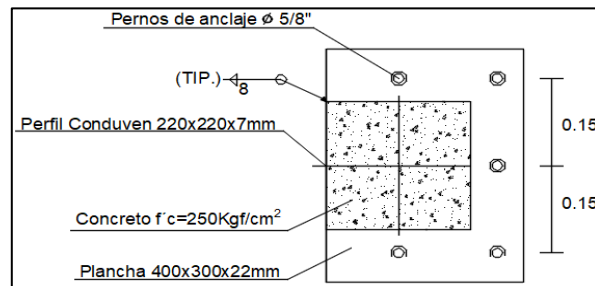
Detallado de sección de columna mixta rellena de concreto $f'c=250\text{Kgf/cm}^2$.
